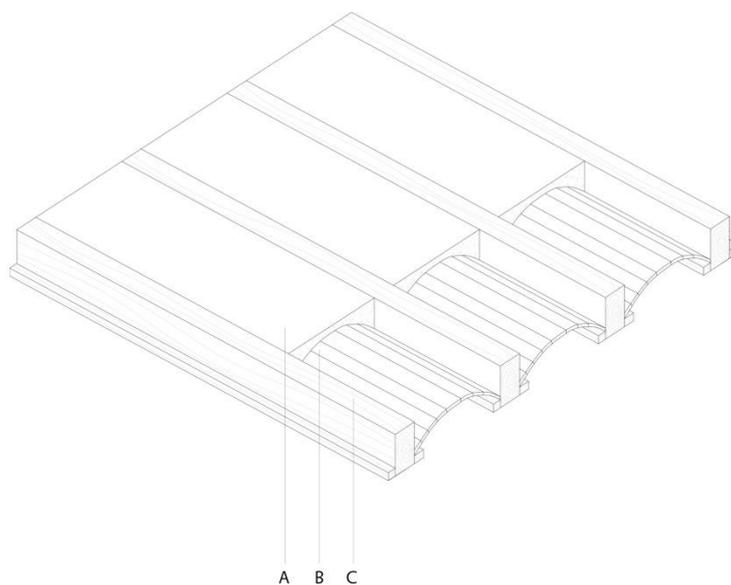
Vivienda en c/Maestro Serrano, 13. Forjado de primera planta.
